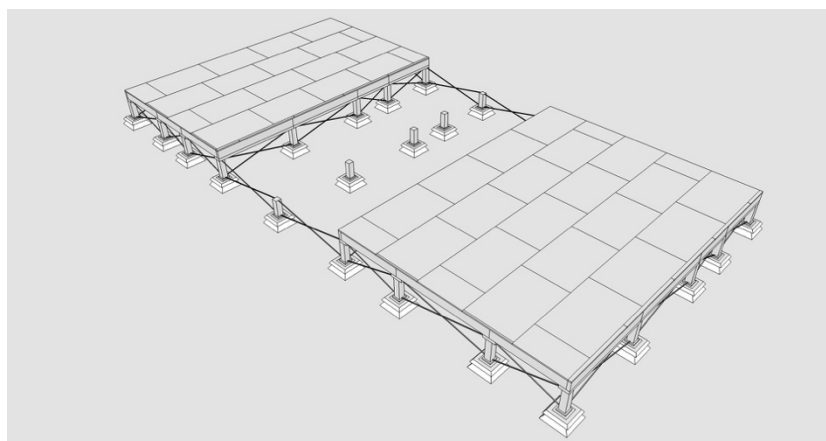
Execução da armação de pavimento (colocação do forro estrutural de pavimento)
